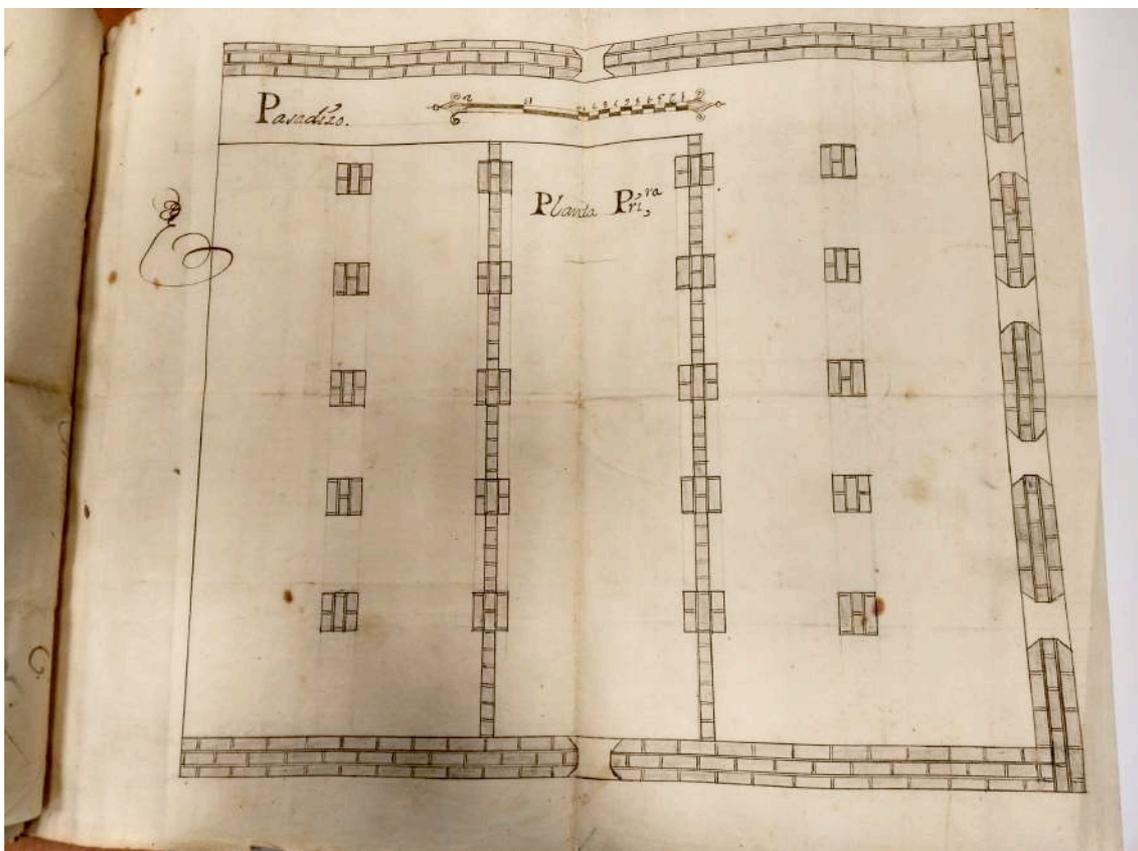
FIGURA V. Planta Primera del pósito y alhóndiga de Burgos en 1742¹²⁸
